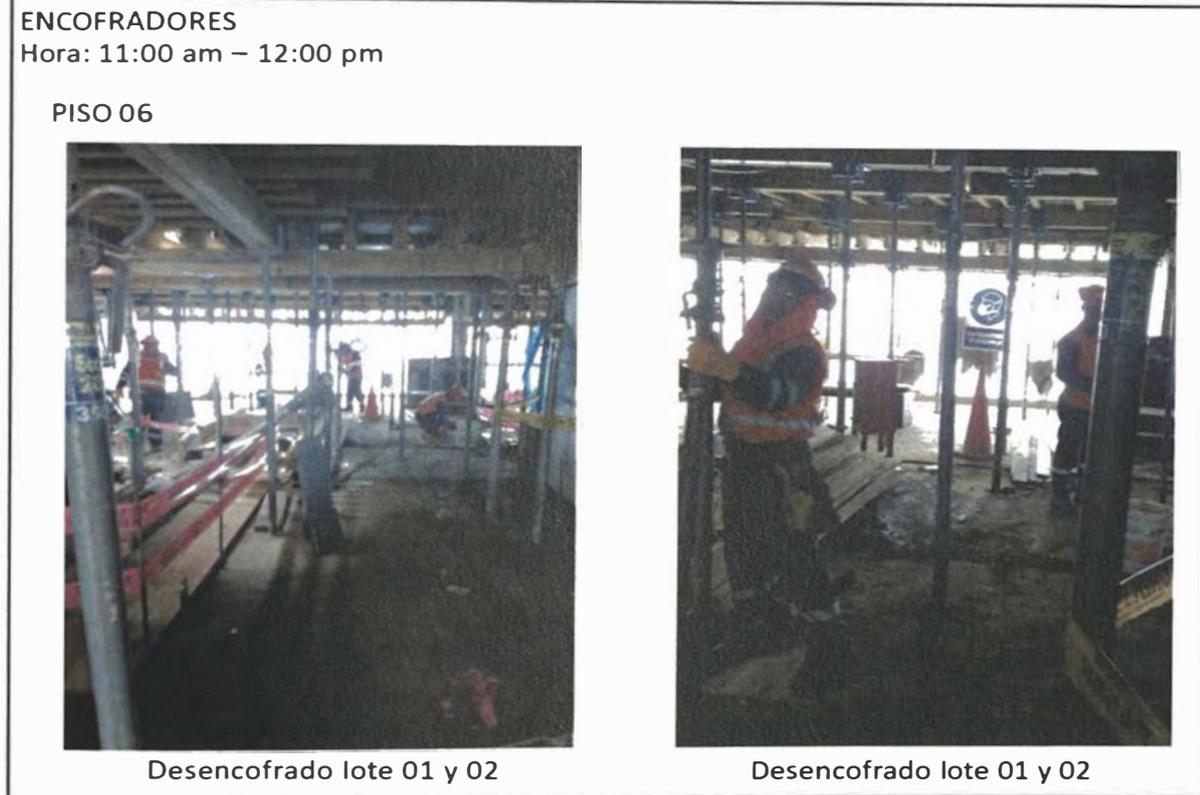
Material y piezas de encofrado utilizado en el Piso 06
